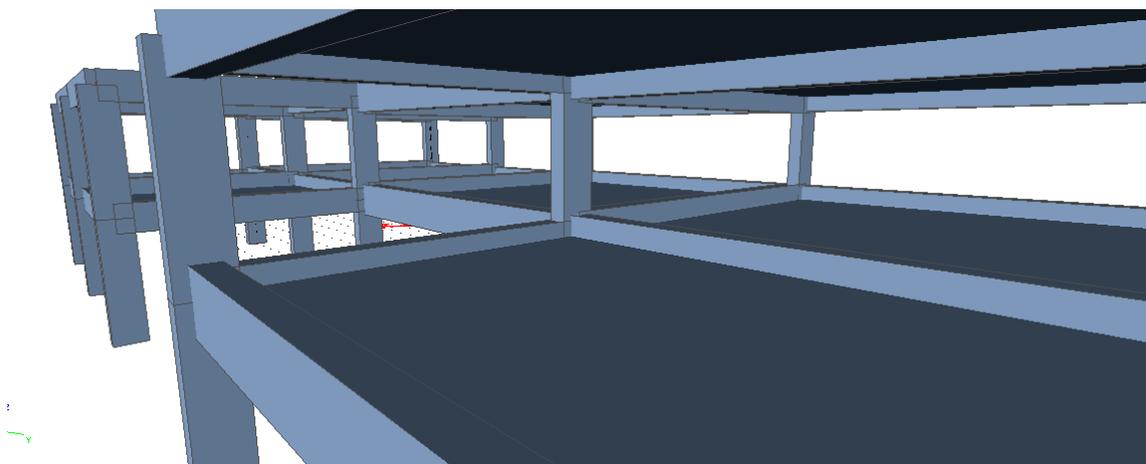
Estrutura de concreto – Vista de dentro da edificação
